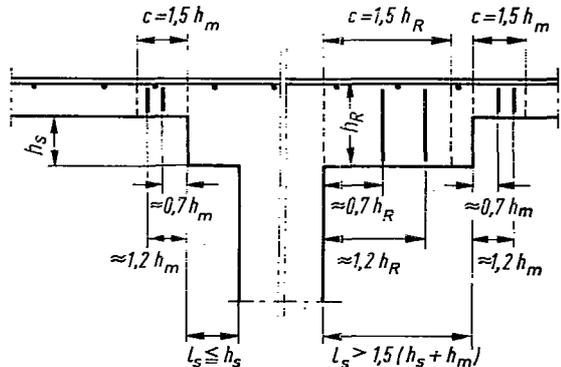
Pilzdecke mit Stützenkopfverstärkung bei Durchstanzgefahr (Beispiel für Schubbewehrung)
